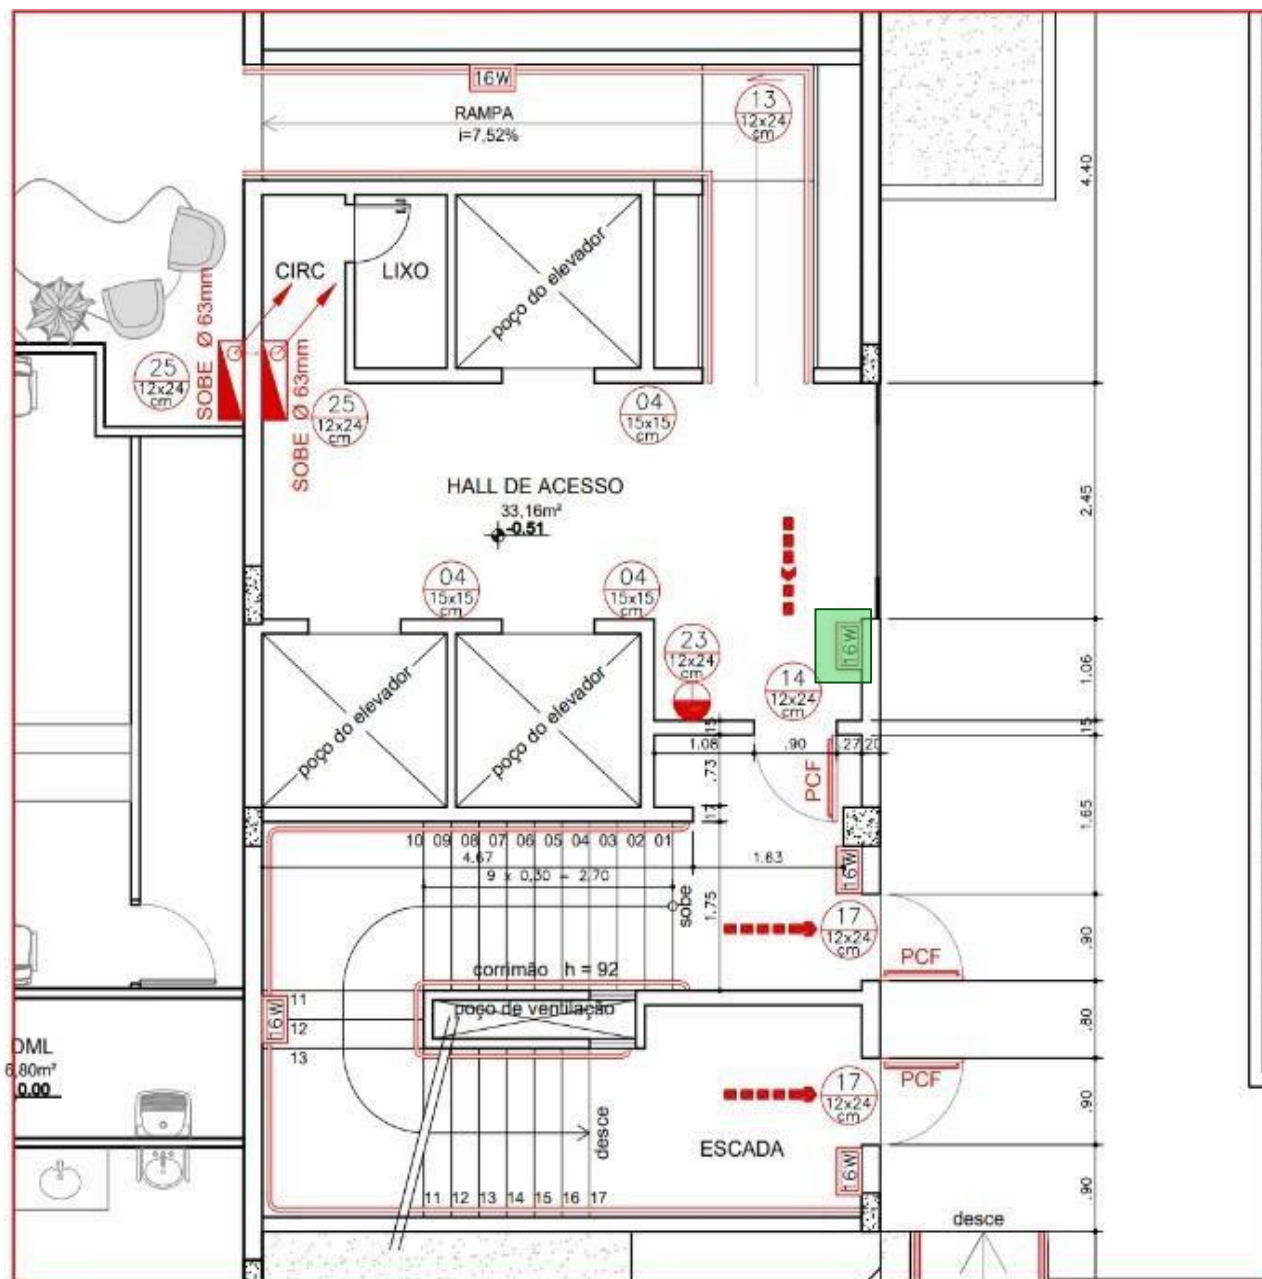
Planta baixa do layout proposto, destacando a localização das luminárias de emergência.
